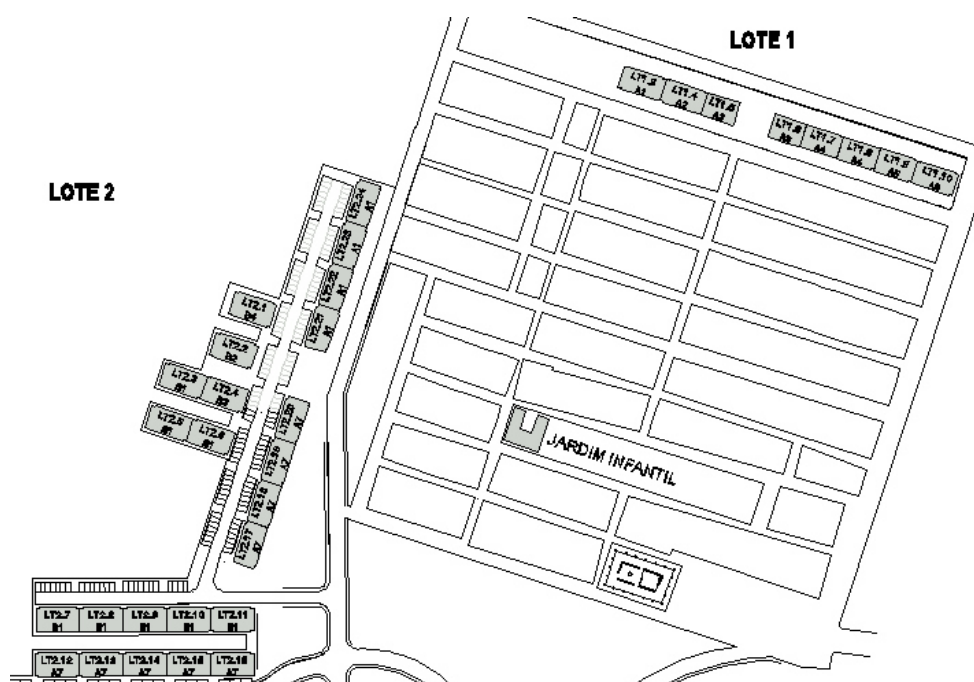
Obra Casa para Todos BV3 – Planta geral de localização dos lotes e edifícios
